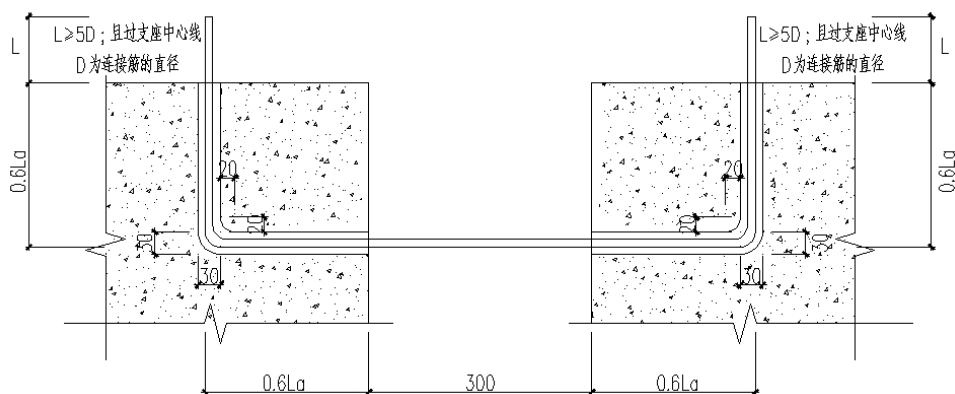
不出筋叠合板后浇区端部]型连接筋平面图
